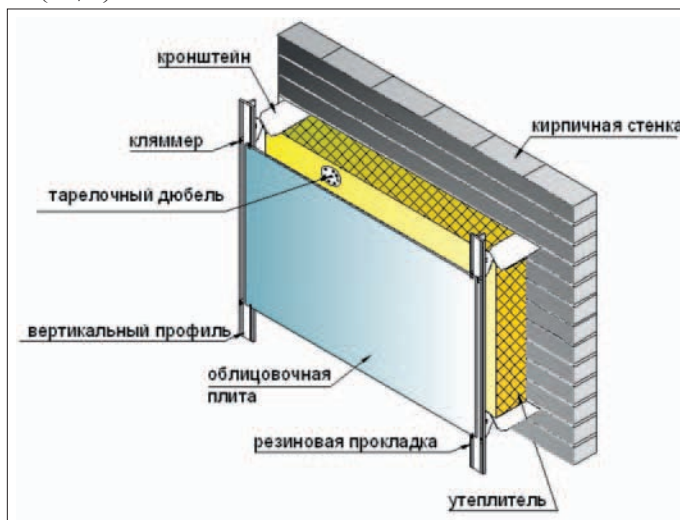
Аксонометрический вид разрабатываемой конструкции
